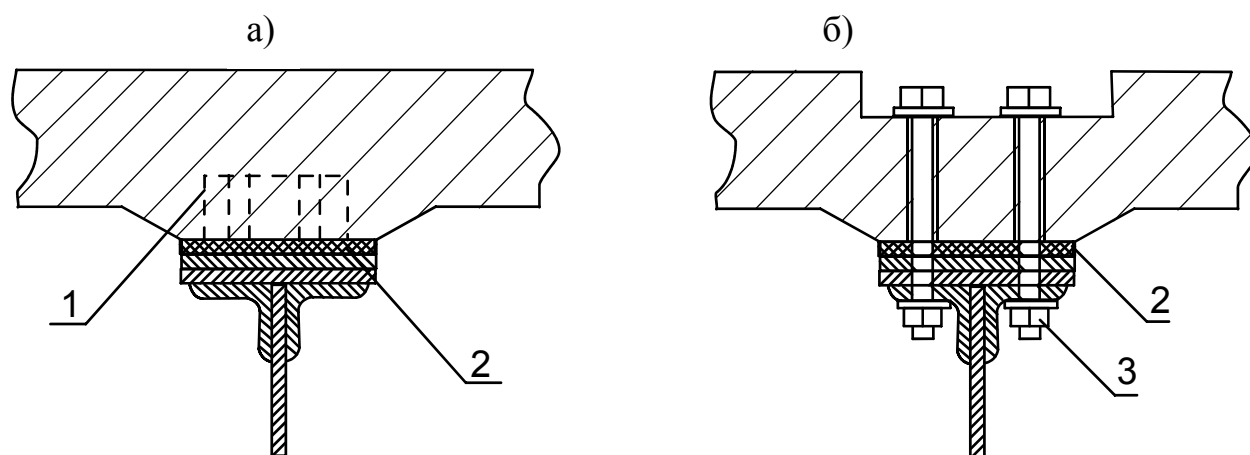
Соединение железобетонной плиты при помощи жестких упоров (а), высокопрочных болтов (б): 1 – жесткий упор; 2 – цементный или клеепесчаный раствор; 3 – высокопрочный болт
